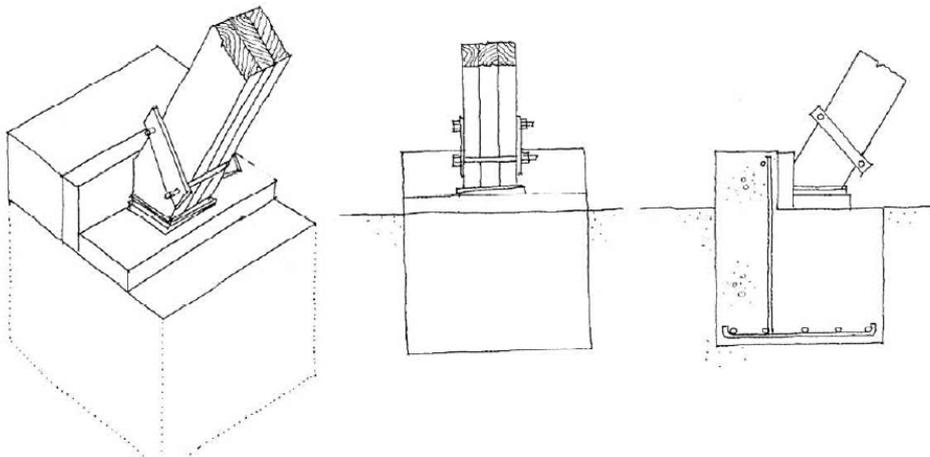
Apoyo de tornapunta en cimiento de H.A. realizado ex profeso.
